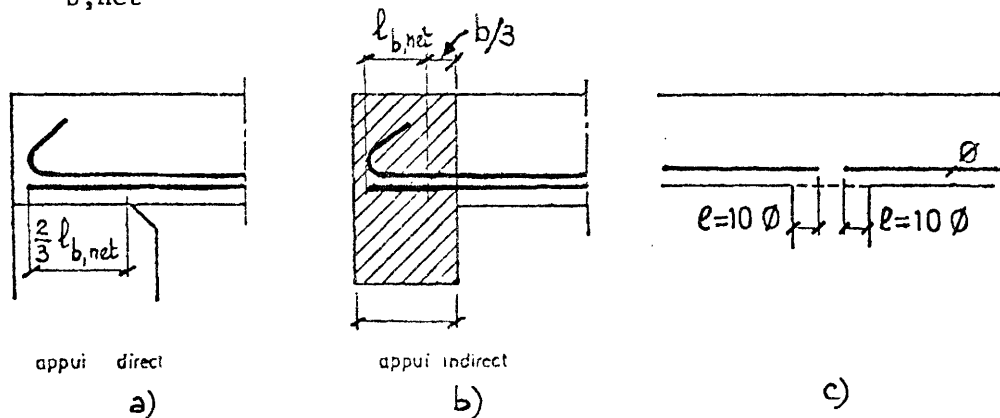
Ancrages sur appuis de rive et sur appuis intermédiaires
